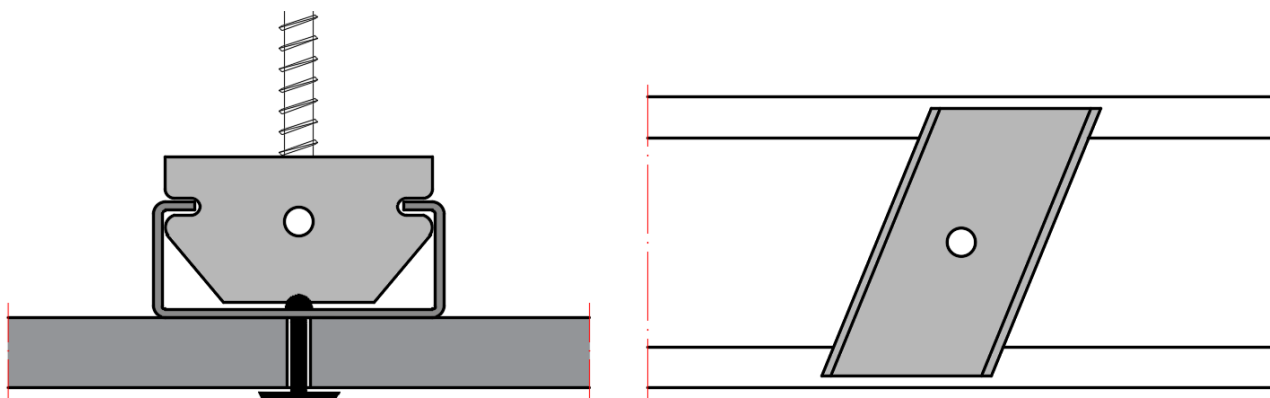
Pormenor de fixação do painel ao perfil de suporte
